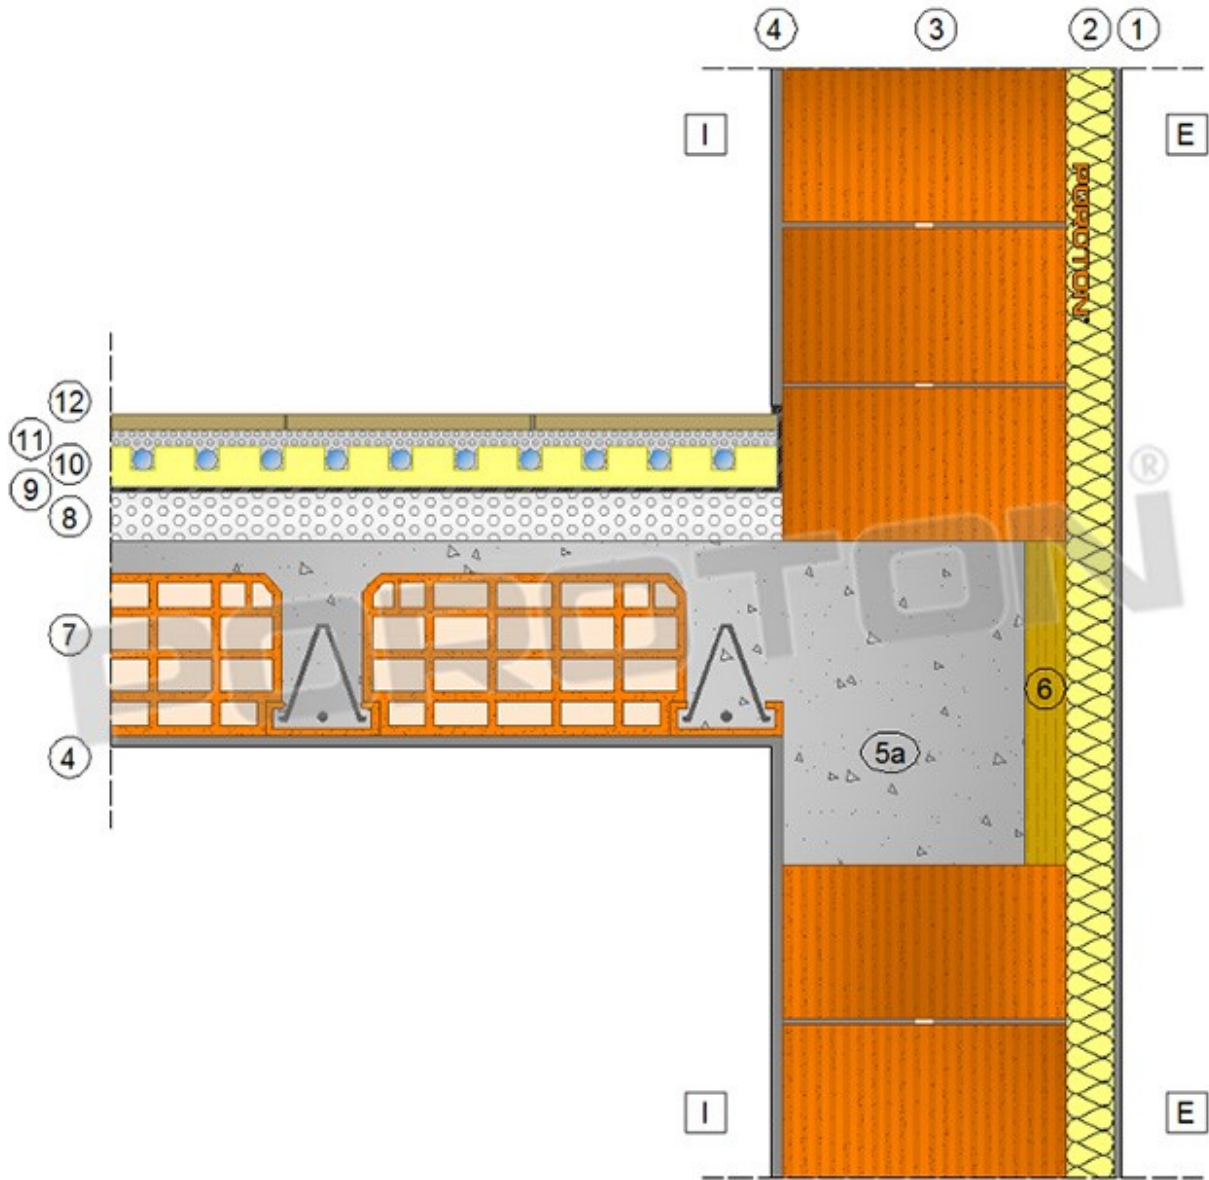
Dettaglio costruttivo del ponte termico dovuto alla connessione tra solaio con trave in c.a. e tamponatura esterna (PT4).
